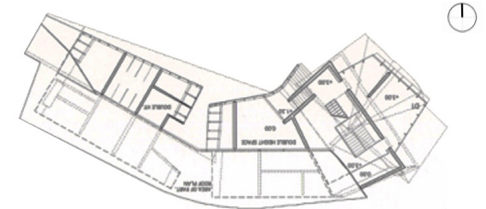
Pianta piano primo; Fonte: Mary Guzowsky,2010;
